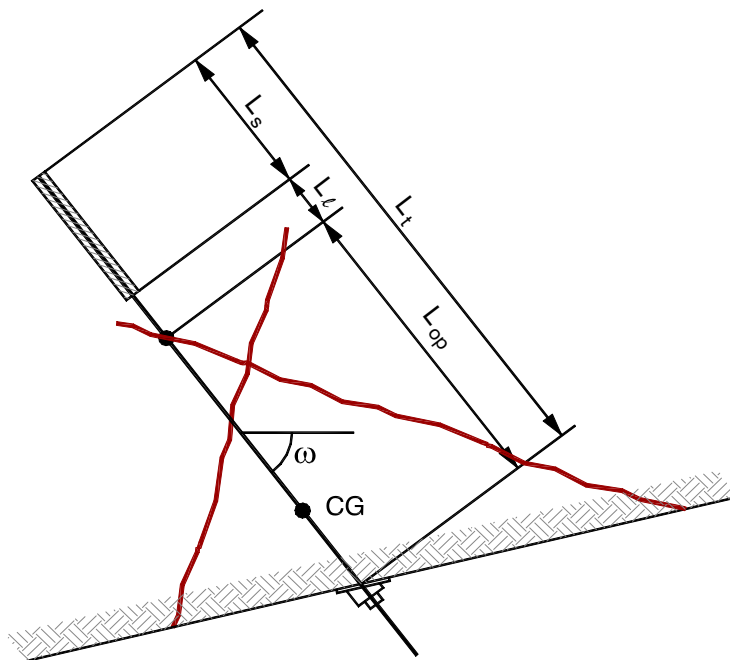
Section verticale passant par le centre de gravité d'un tétraèdre découpé au toit d'une excavation souterraine et contenant la tige d'ancrage scellée dans un trou de forage d'implantation.
